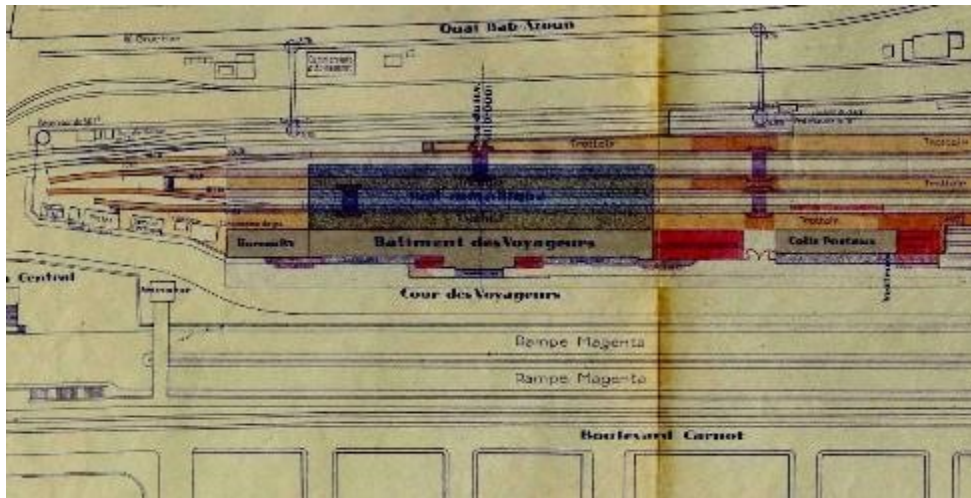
Disposition latérale conforme de la gare d'Alger, Centre des archives SNTF, Alger
